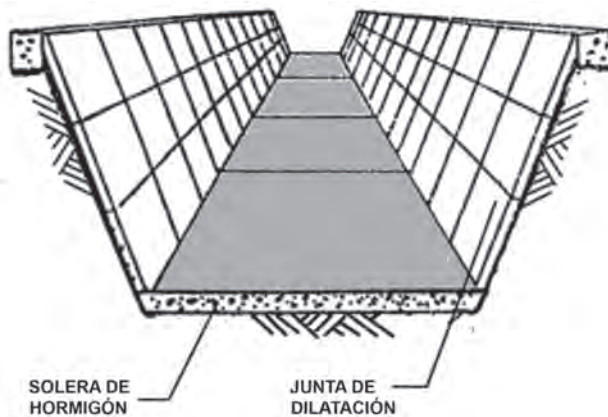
Revestimiento de un canal en concreto, con juntas de dilatación.
